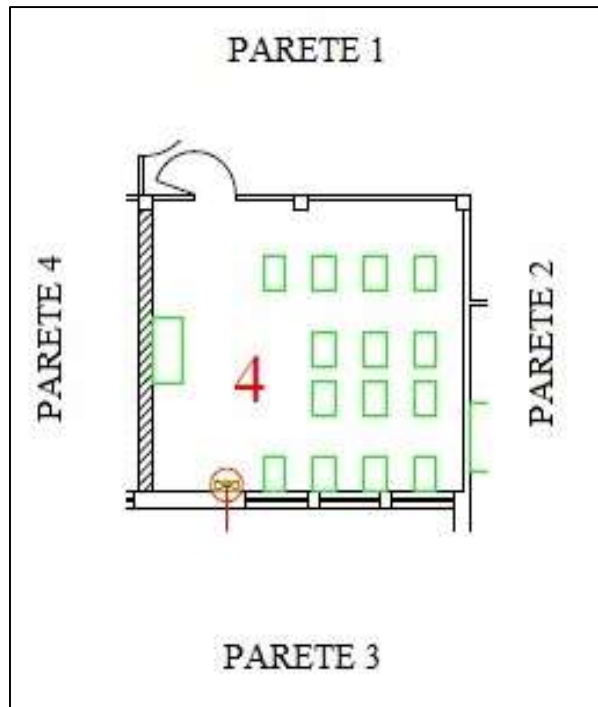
Planimetria dell’Aula 4 (2°A) oggetto di misurazioni
